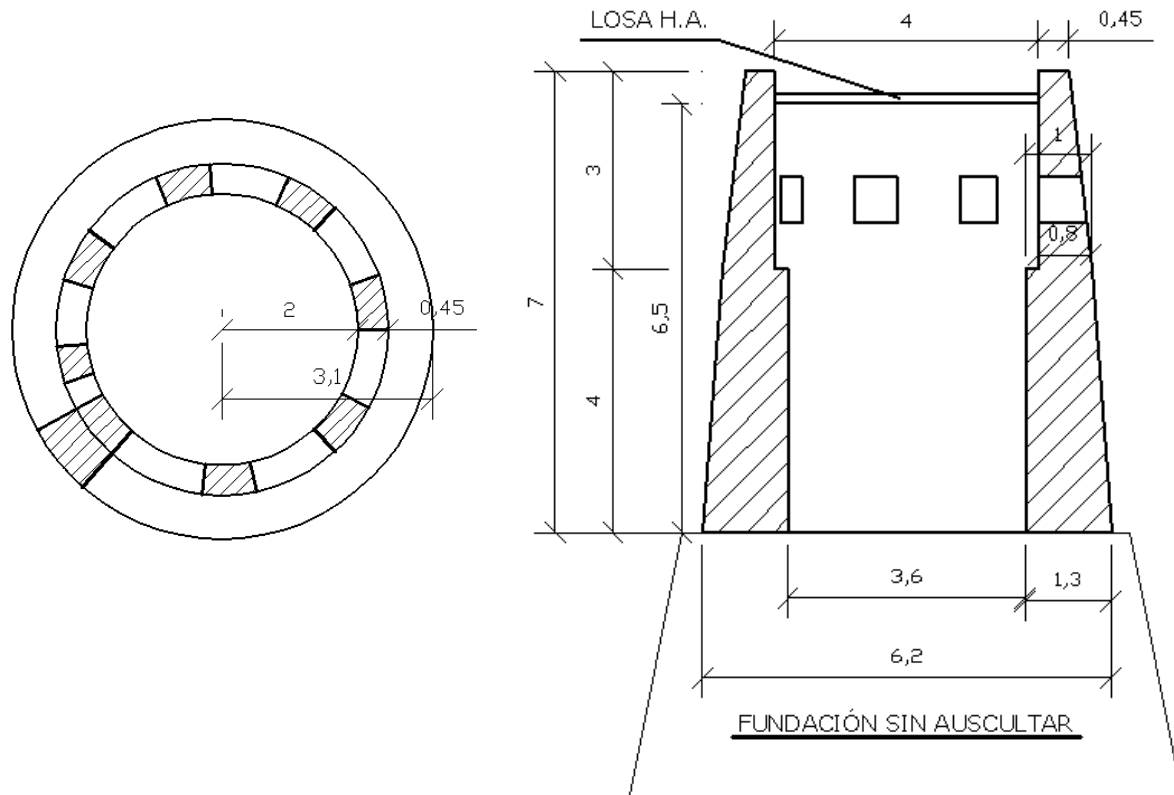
Imagen del plano de la geometría del Torreón Los Canelos, obtenida tras el levantamiento estructural.
